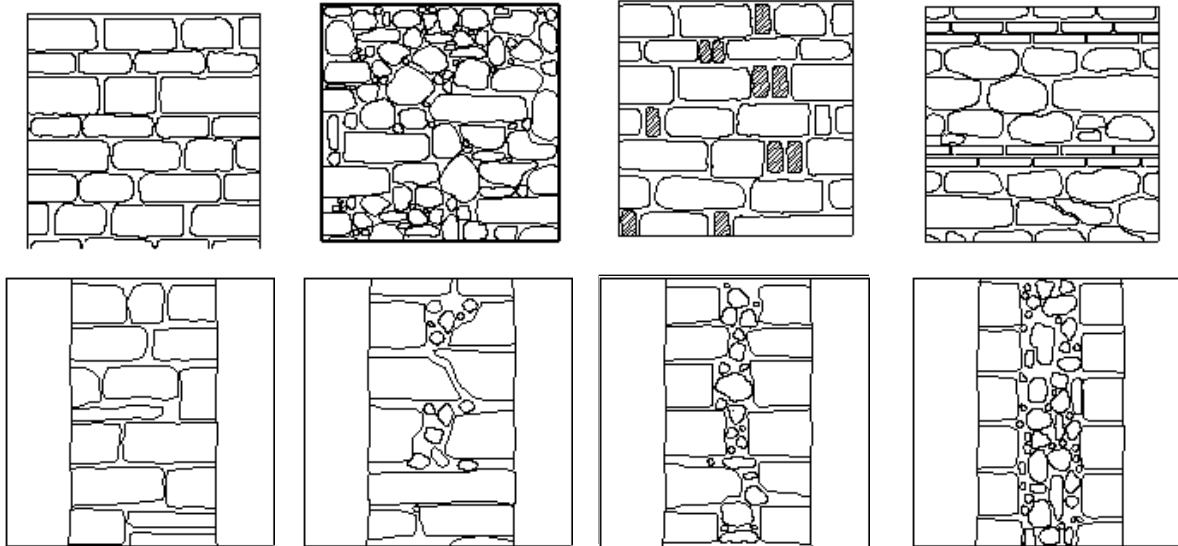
Diferentes tipos de alvenaria de pedra (em cima: alçados; em baixo: cortes transversais).
